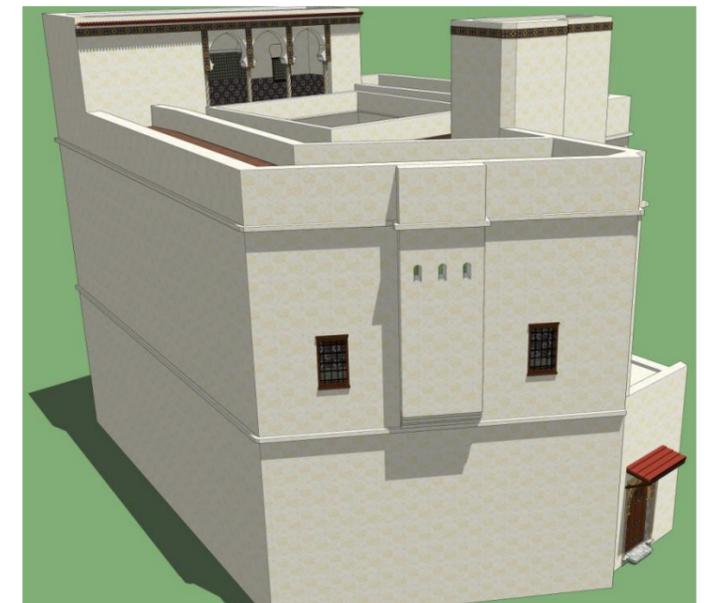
vue sur l'encorbellement sur façade. (Source : Auteure).
